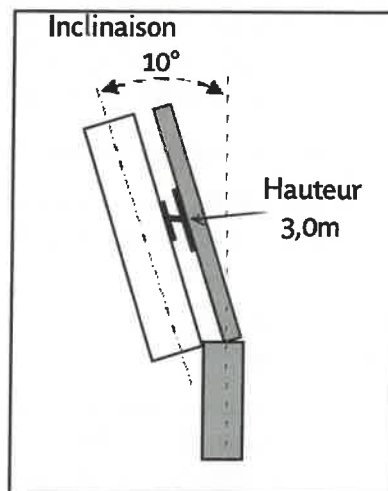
Coupe transversale – Inclinaison des diffuseurs.
